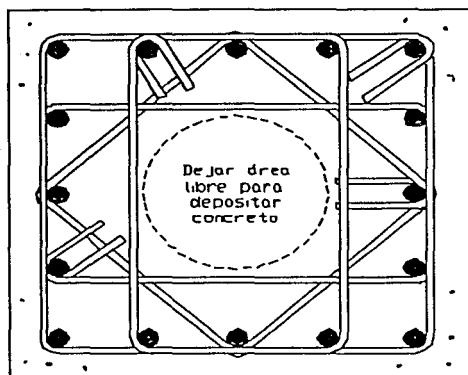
Acero de confinamiento en columnas sujetas a fuerzas sísmicas intensas. (1.1)
